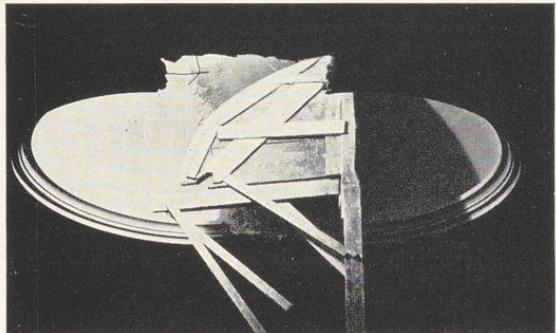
Kleines Muldengewölbe für indirekte Beleuchtung auf einer Rabitzdecke mit dem drehbaren Flügel ausgezogen
